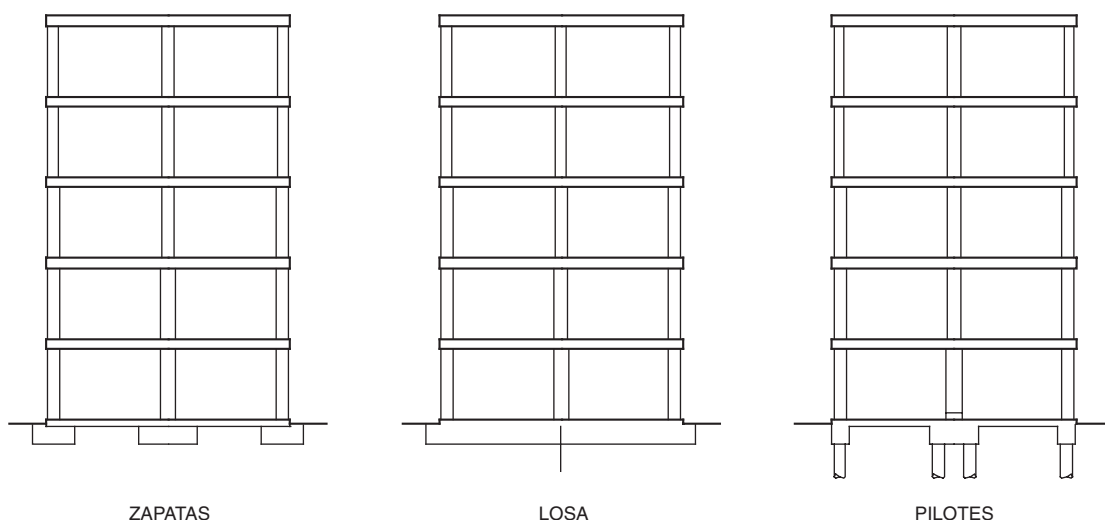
Ejemplos de cimentaciones adecuadas
